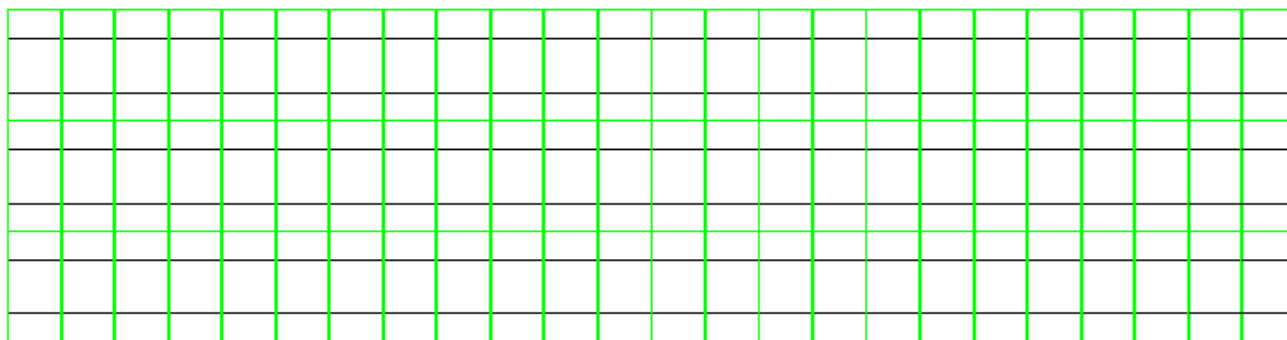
Vista in pianta tipo, struttura fissa con moduli fotovoltaici
